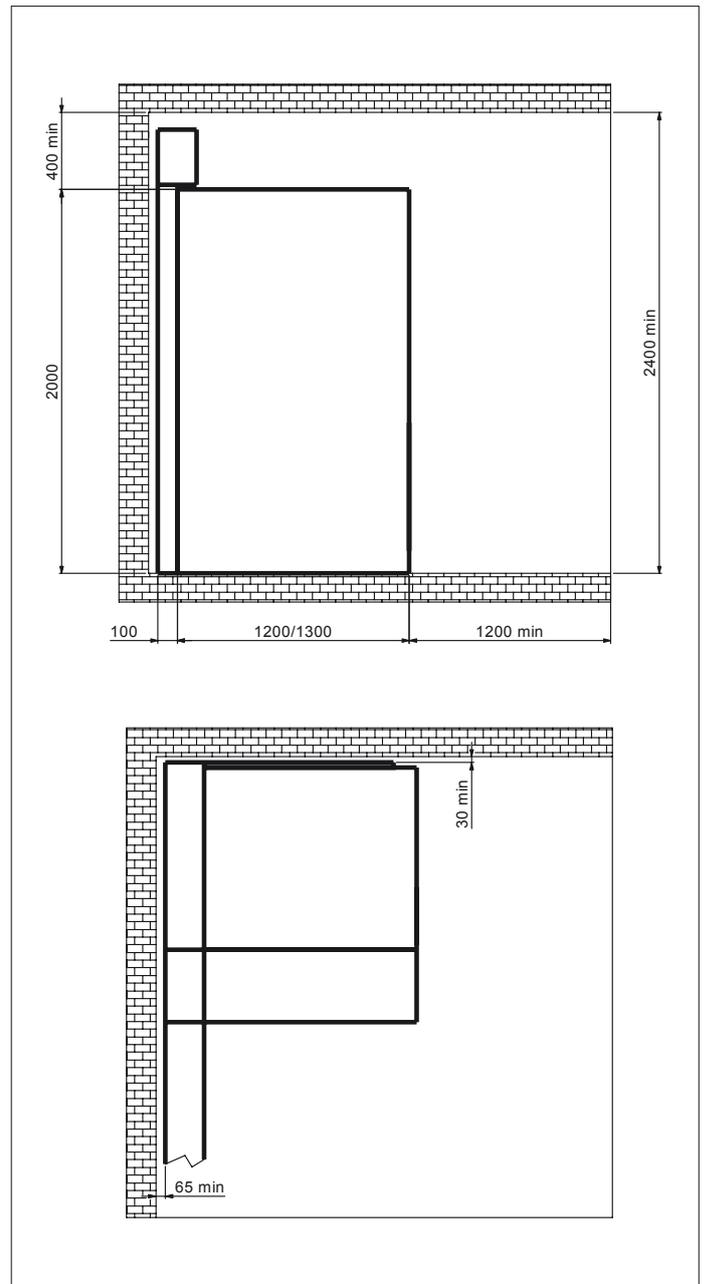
Distanze minime rispetto alle pareti del locale, soluzione IAC A-FLR 25 kA, 1s @ 12-17,5 e 21 kA, 1s @ 24 kV con condotto sfogo gas
